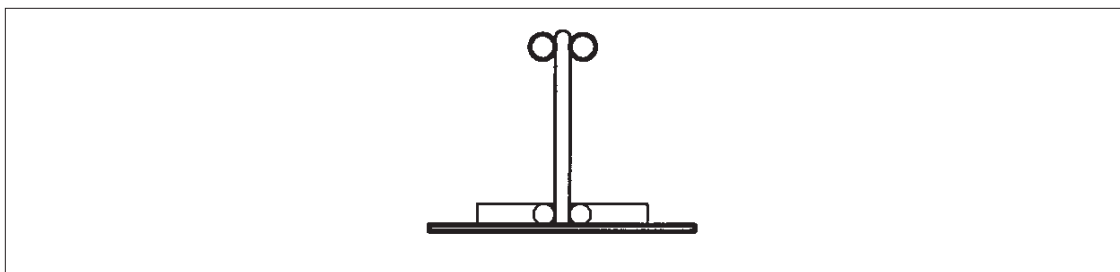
Trave con fondello in acciaio e traliccio piano preformato.
